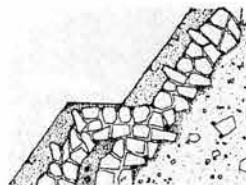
Detalle: sistema Constructivo de la Pirámide.
